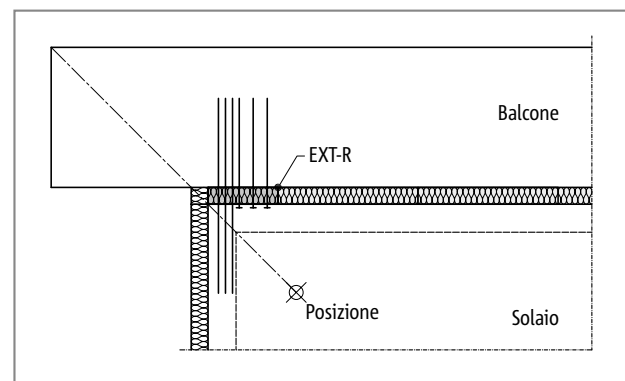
Schöck Isokorb® tipo EXT: balcone a sbalzo lungo l'angolo dell'edificio (impiego tipo EXT-R)
